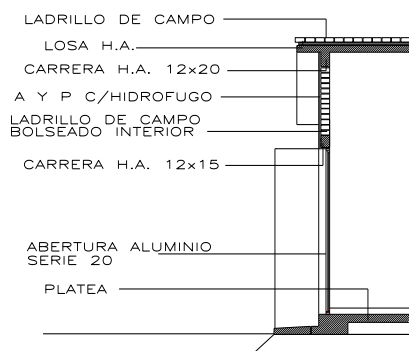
Ejemplo de sistema constructivo utilizado para tipología PIAI.
